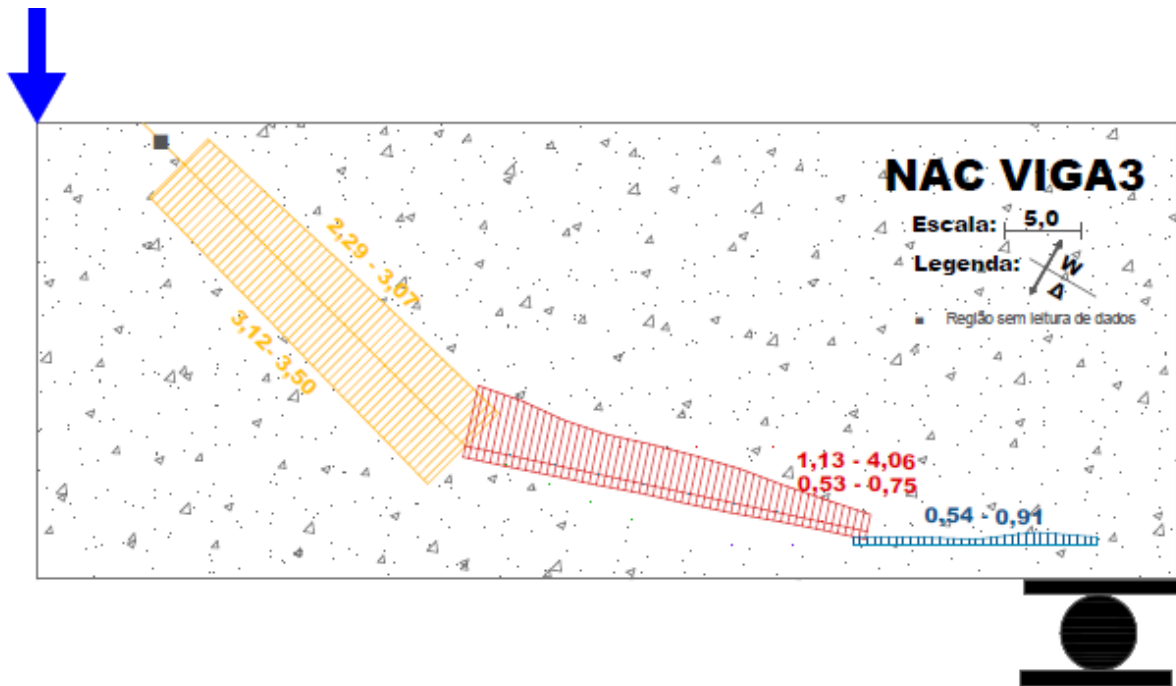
Abertura (w) e deslizamento (Δ) da fissura diagonal crítica da viga NAC-3.
